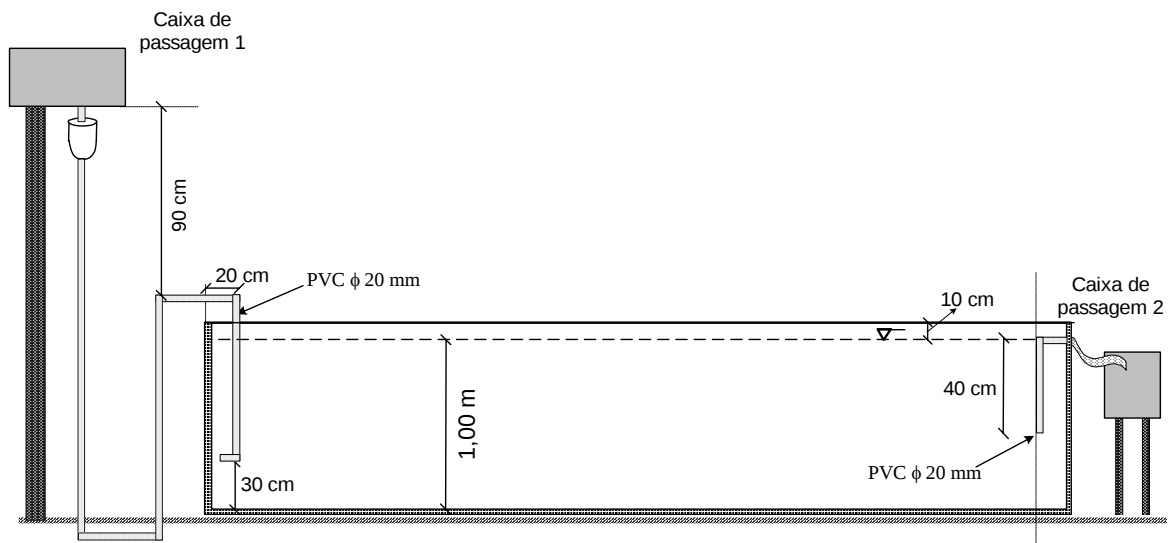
Lagoa 1 - corte BB da planta baixa
